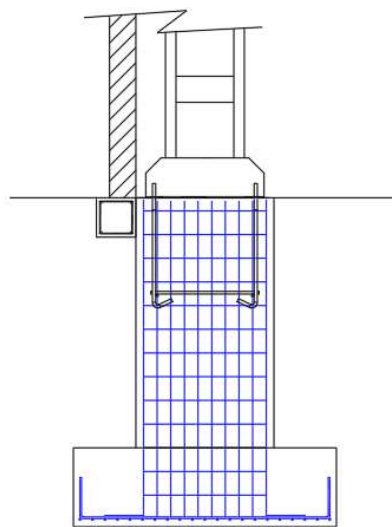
DETALLES DE PLACAS DE ANCLAJE.
